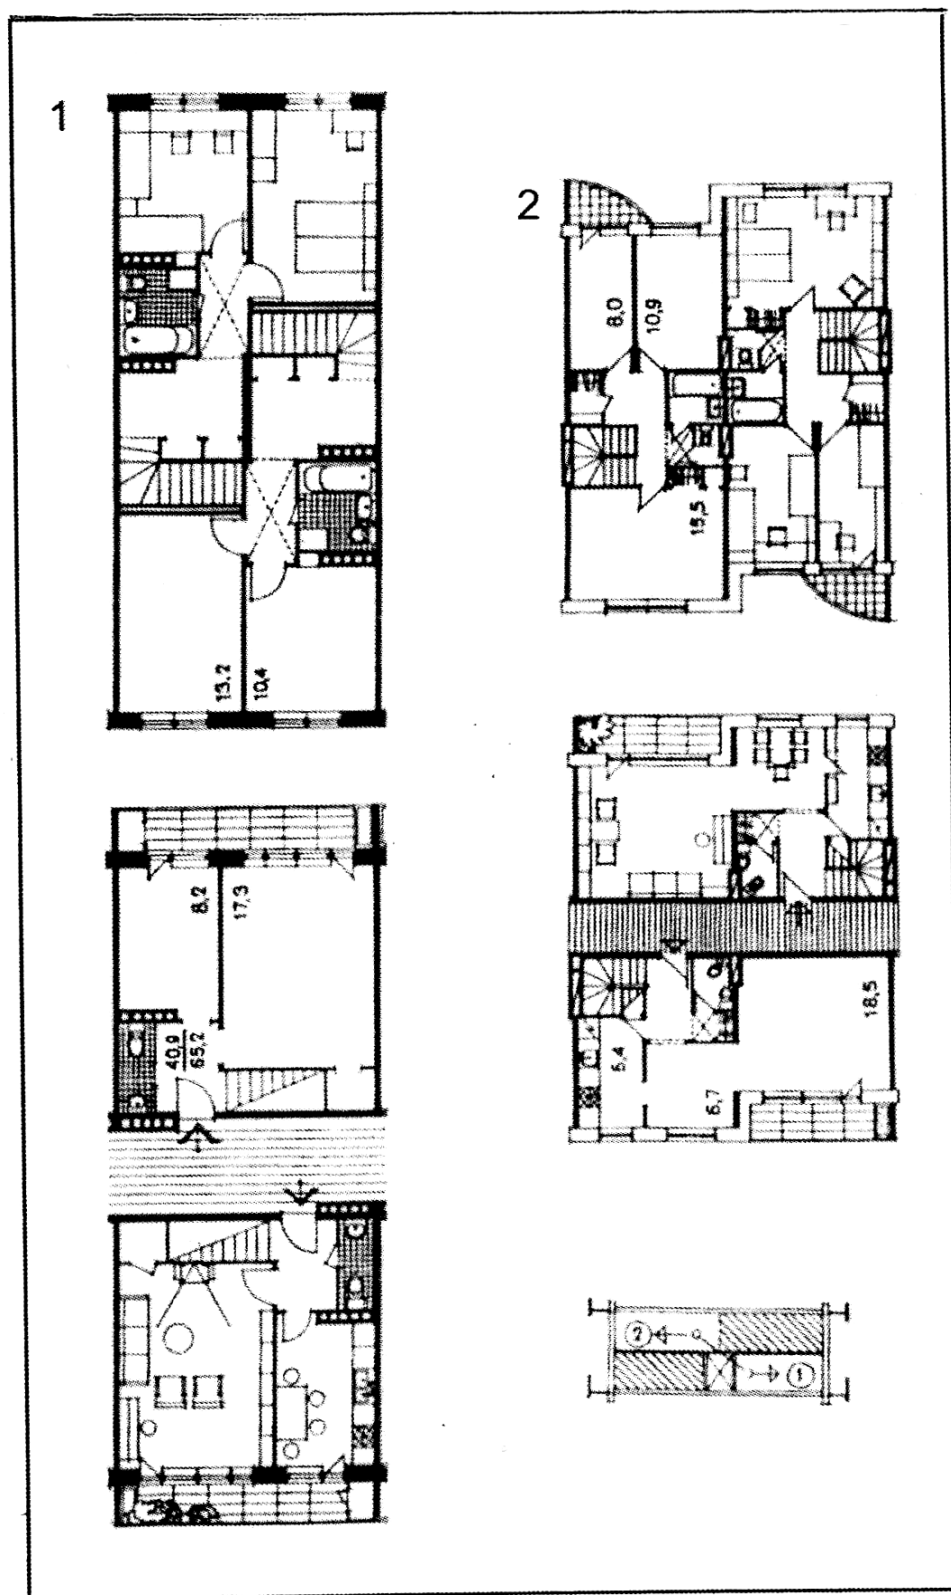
План квартир в двух уровнях в коридорном доме с коридором через этаж: 1 – использован прием «перекидки», 2 – прием «перехрестной планировки»
